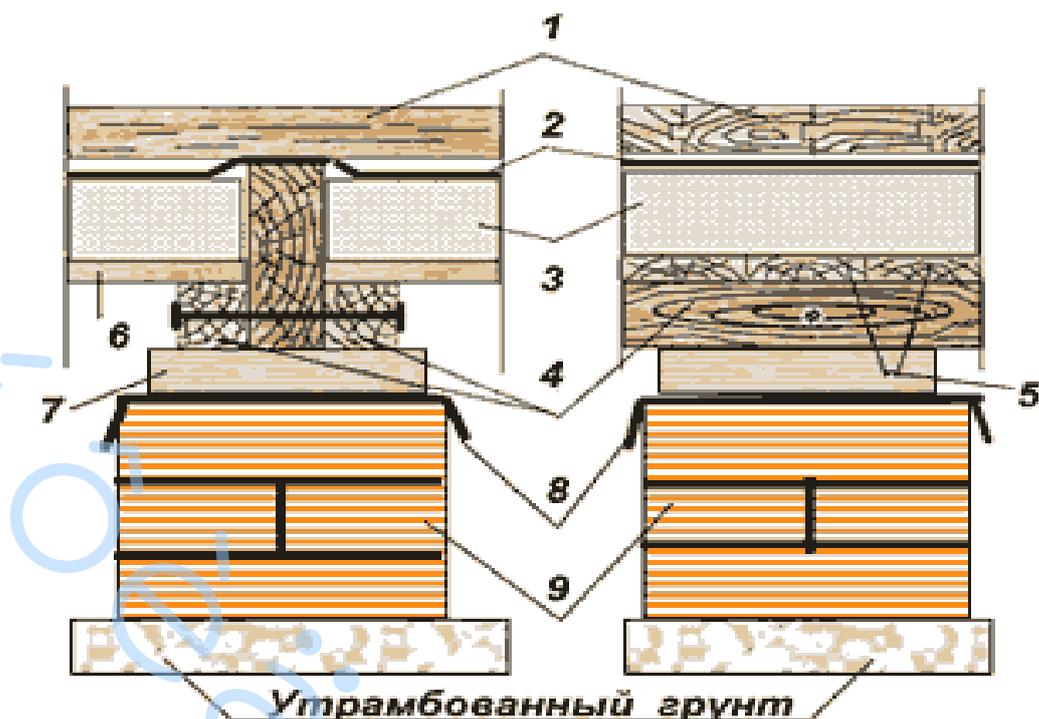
Устройство цокольного утепленного перекрытия по кирпичным столбикам:
